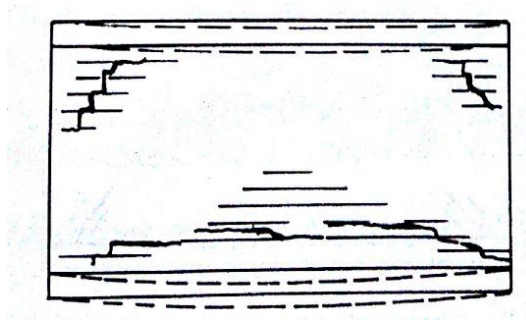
Trincas em parede de vedação: deformação do suporte maior que a deformação da viga superior- Fonte: THOMAZ (1989)
